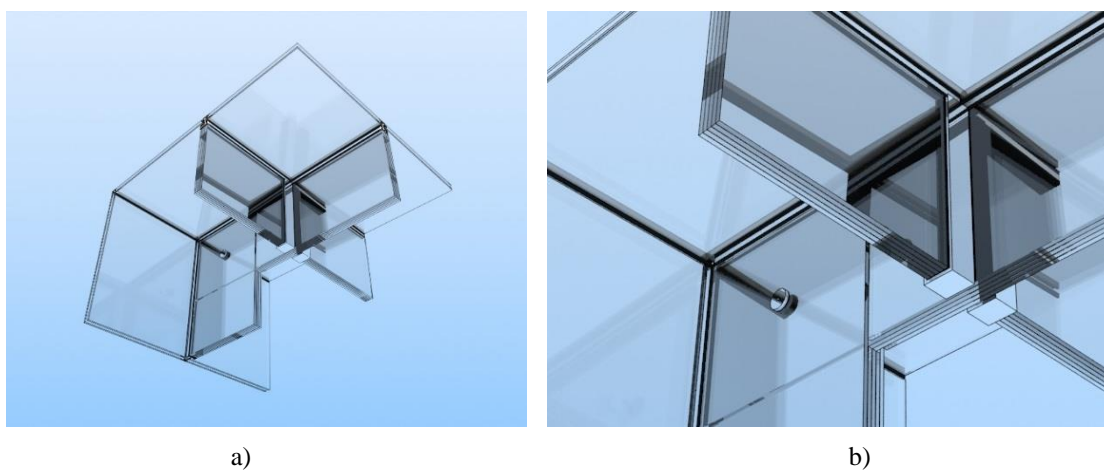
Sistema de ligação entre vigas e entre vigas e *glass fins* (GLASSCON GmbH, s.d.)
